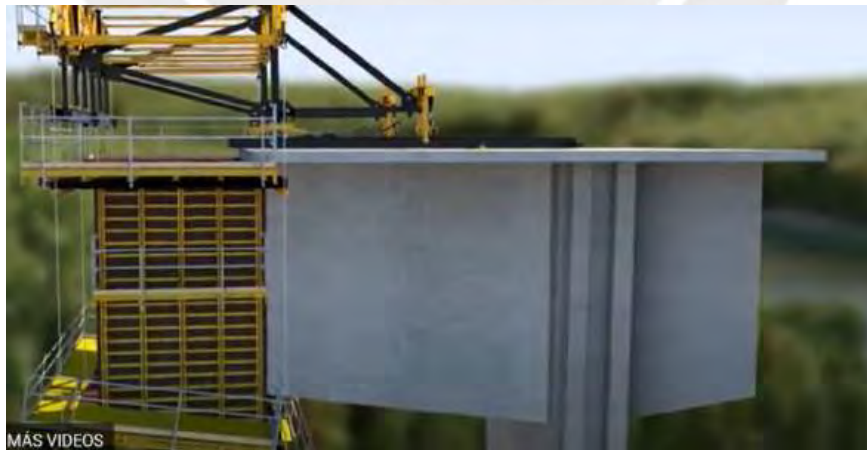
Vista de perfil – Sistema de carro de encofrado
